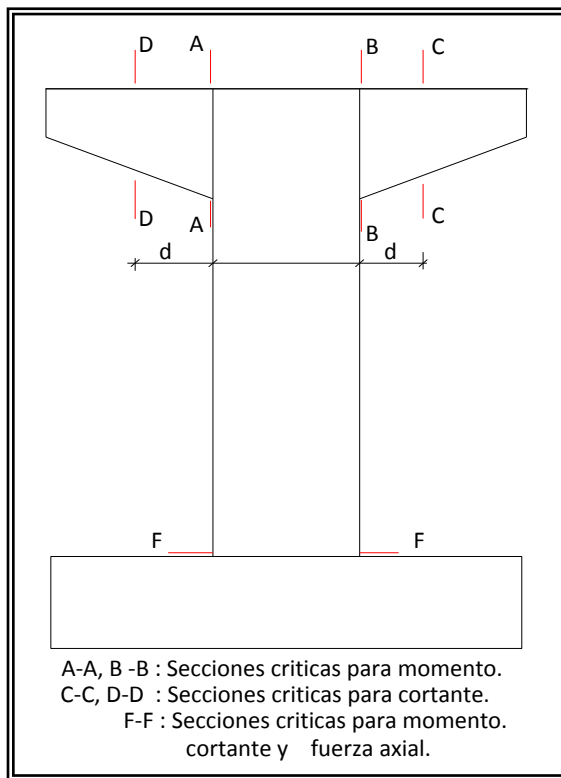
Secciones críticas de la columna y de las proyecciones de la cabeza de una pila tipo cabeza de martillo.
